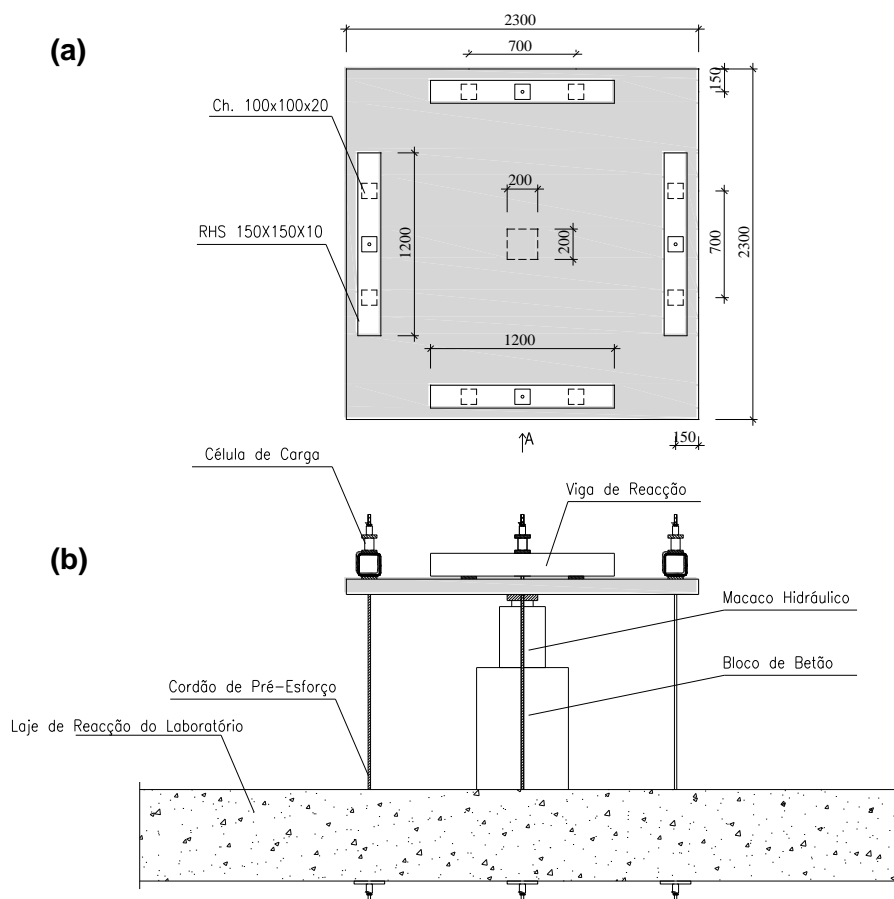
Geometria dos modelos, (a) planta e (b) vista por A (desenho sem escala e dimensões em mm).
